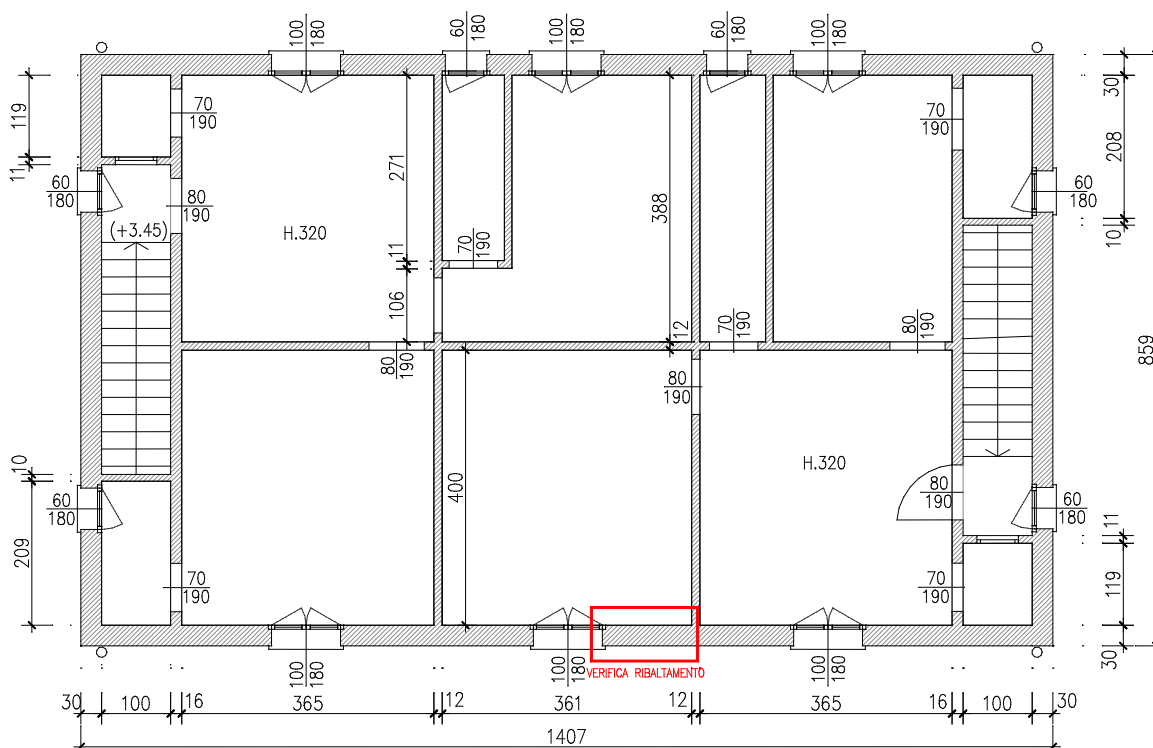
Palazzina C – PIANO PRIMO – Individuazione della parete oggetto di verifica
